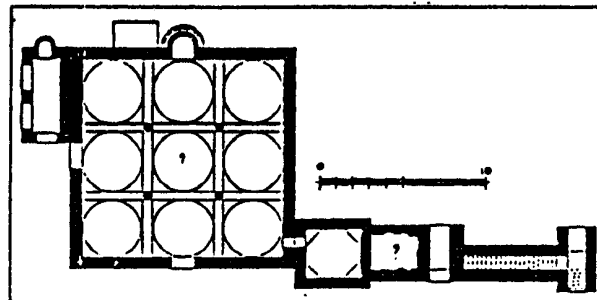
مسقط أفقي لمسجد بلخ في أفغانستان (عن ، Golombek)
